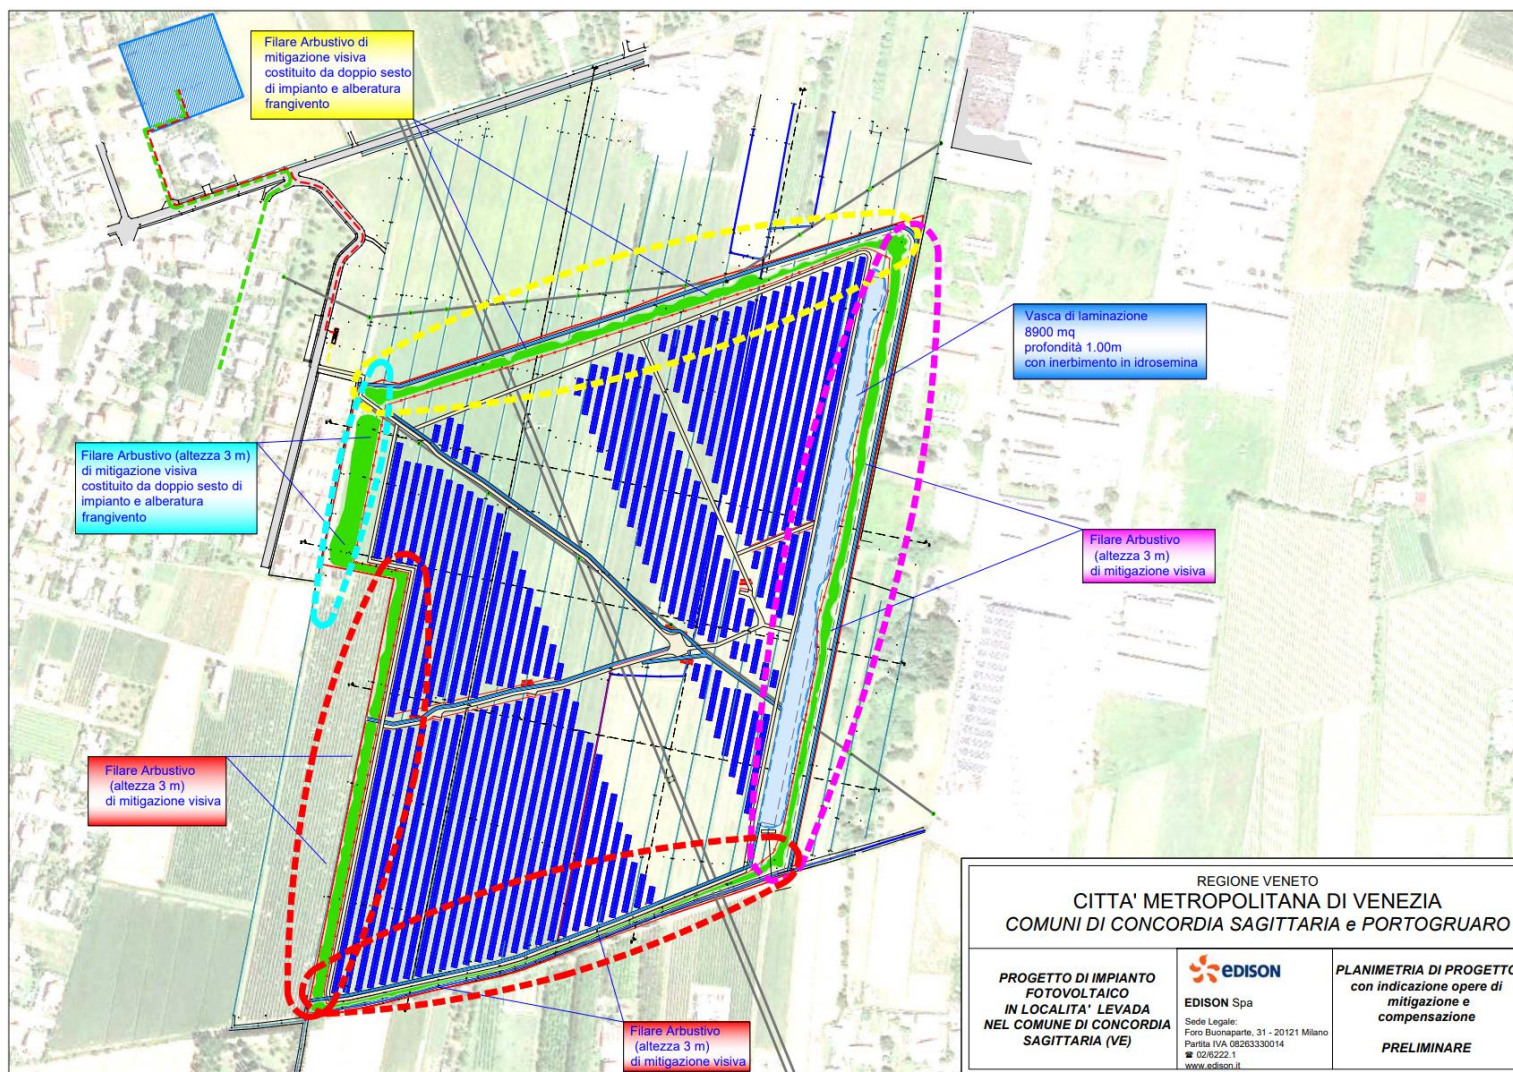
Planimetria con individuazione delle opere di mitigazione
